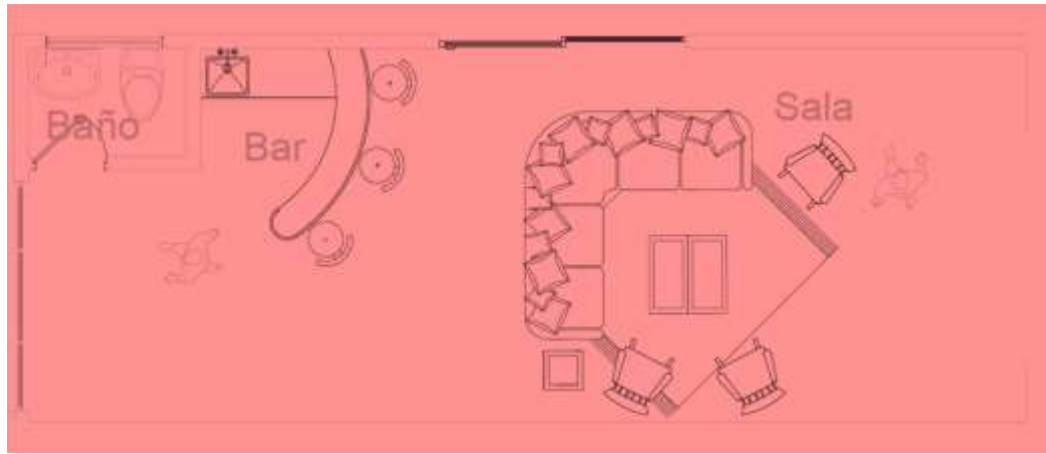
Módulo 1 Planta baja - Vivienda Bioclimática Modular sector Nobol
